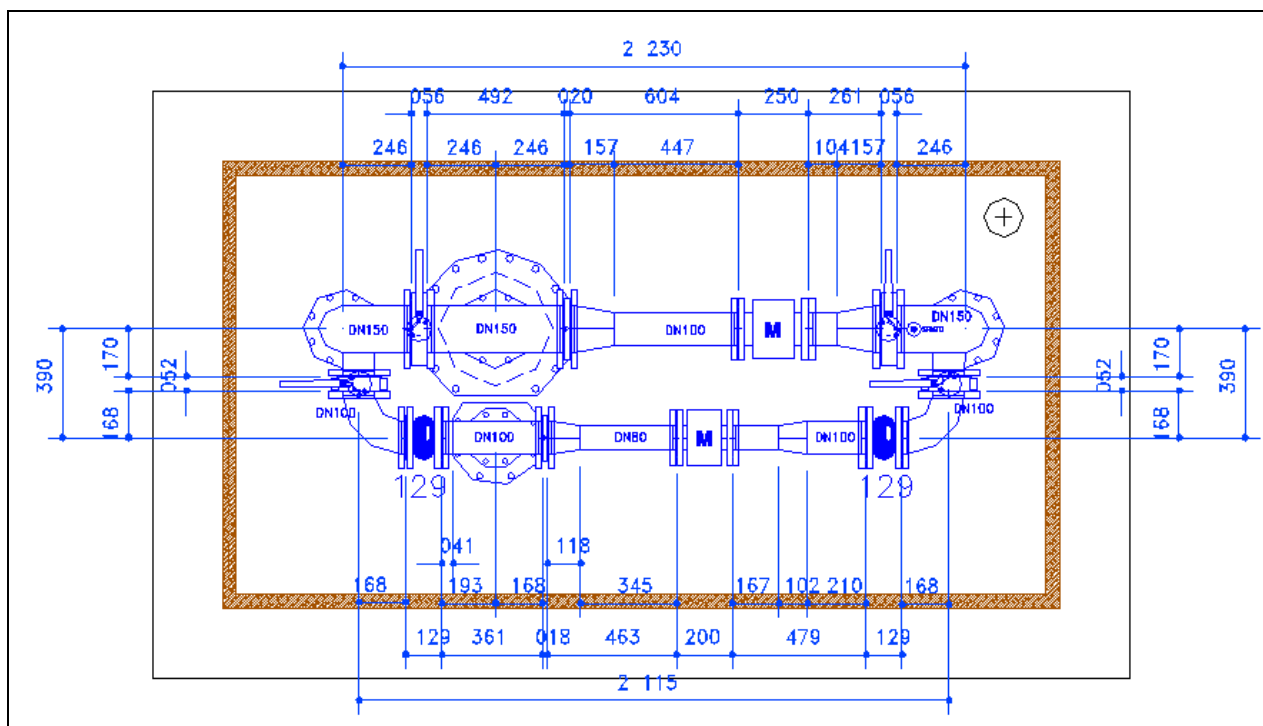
Pianta testata pozzo San Donnino 3.
